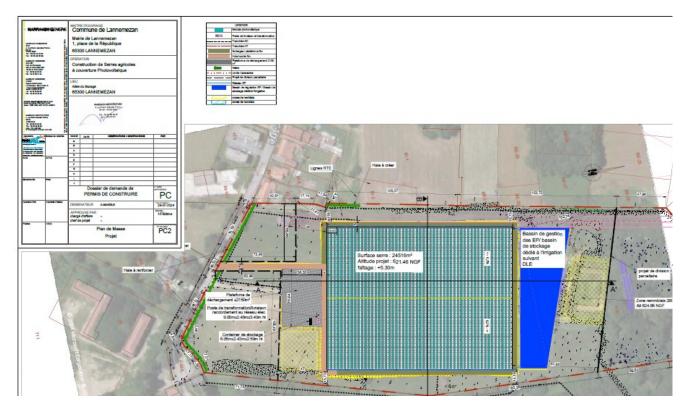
Plan de masse du projet (source : dossier permis de construire)
